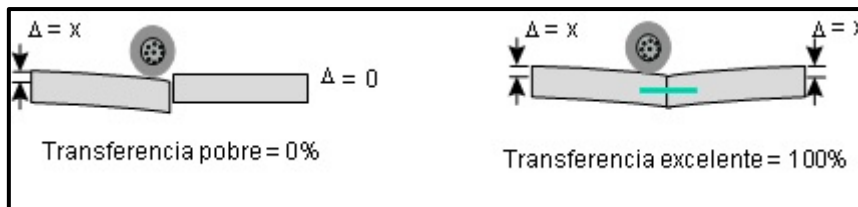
Deflexión de losas contiguas con sistema de transferencia y sin.
